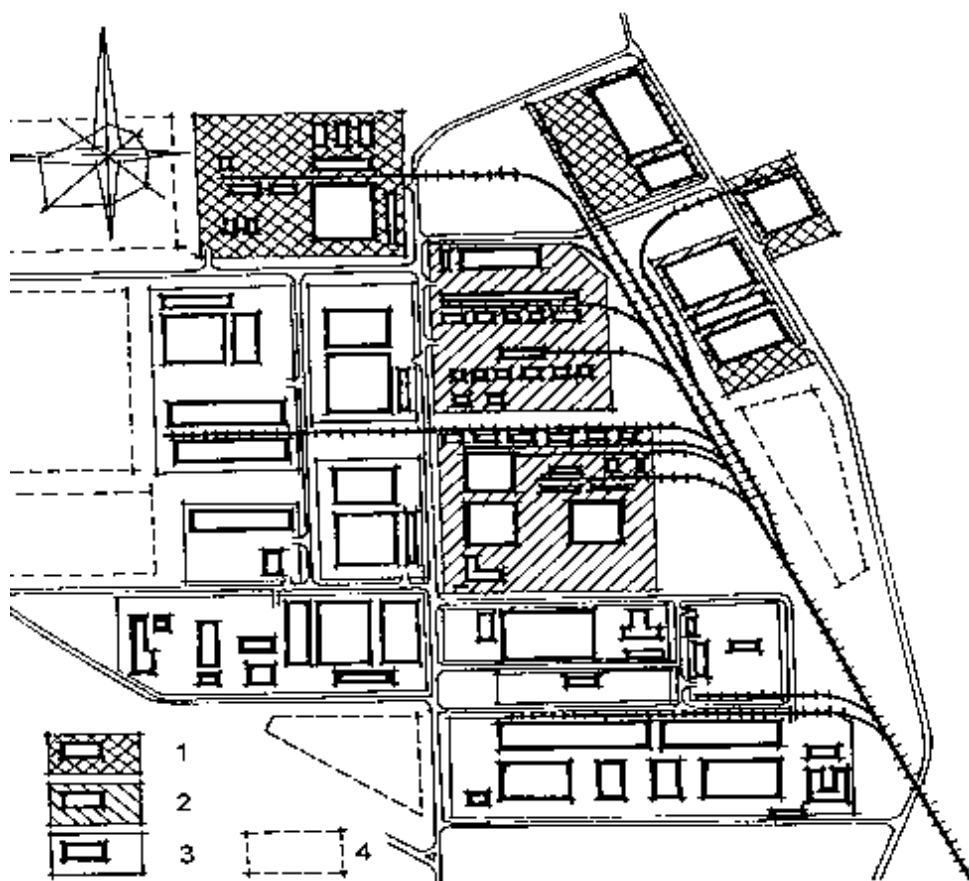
Промисловий вузол. Схема генерального плану:
